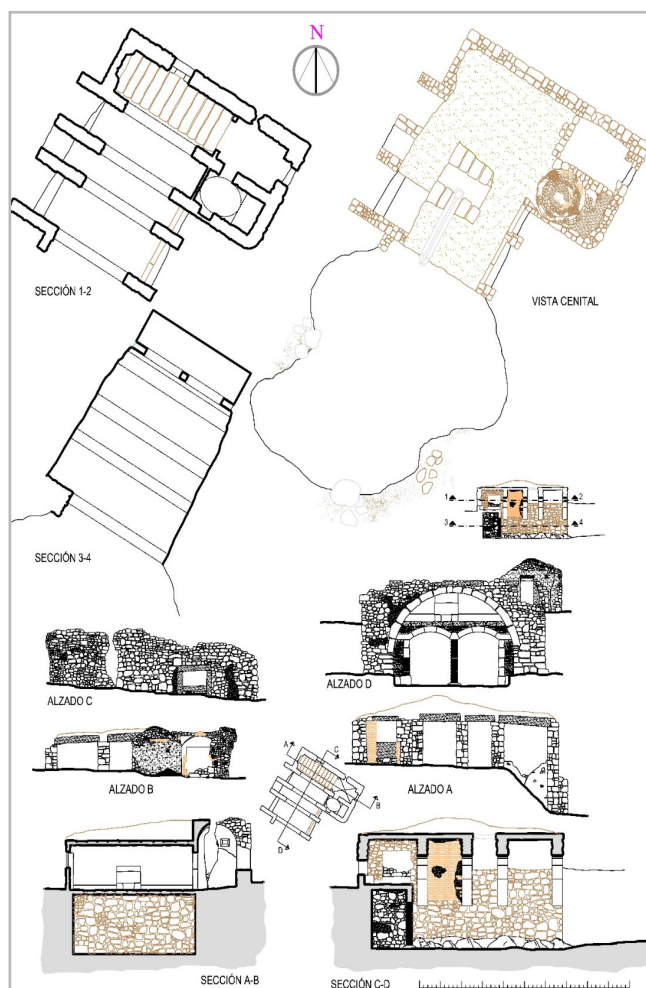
Planos de plantas, alzados y secciones. Originales E.1/50. Fuente: Elaboración propia
